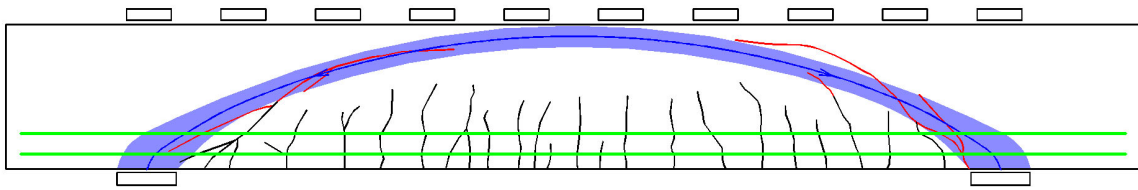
Balken BO 3 mit überlagerter Druckparabel und zugehörigen Rissen
